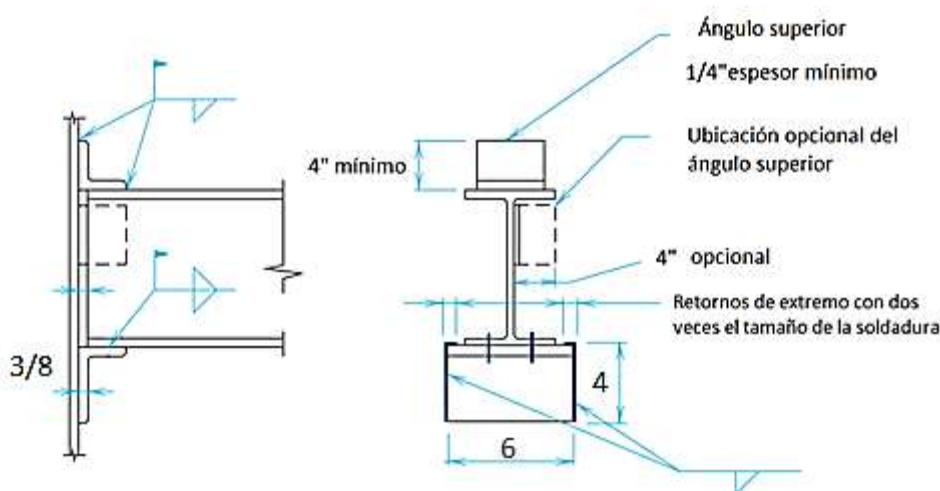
DIMENSIONES DE LA SOLDADURA PARA EL ASIENTO DE VIGAS
